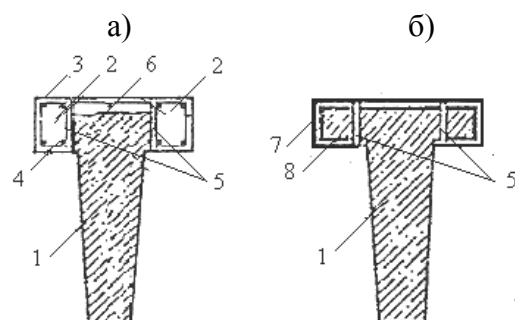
Усиление полок подкрановых балок устройством железобетонной рубашки (а) и рубашки из стеклопластика (б):
